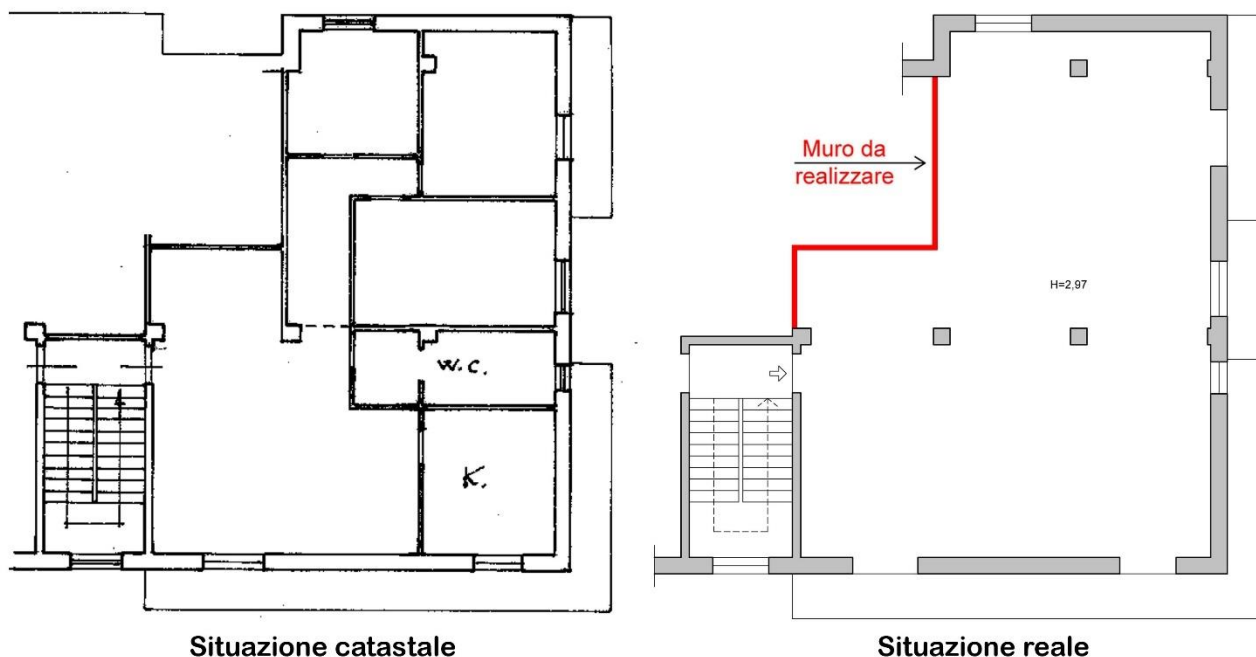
Lotto 2. Piano primo, planimetria catastale.
